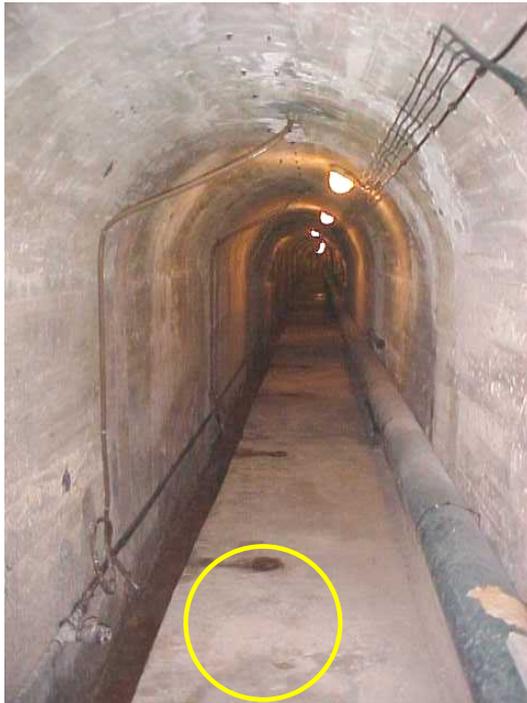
Drenes en galería superior de la presa de Amadorio.
